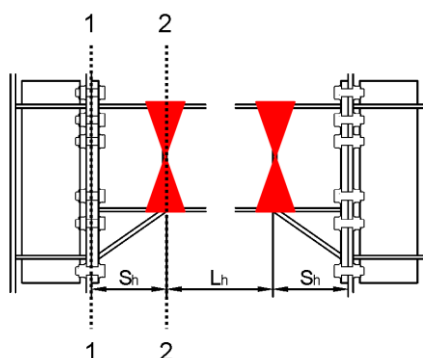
Localização das rotulas plásticas nas juntas com esquadro de reforço de viga
